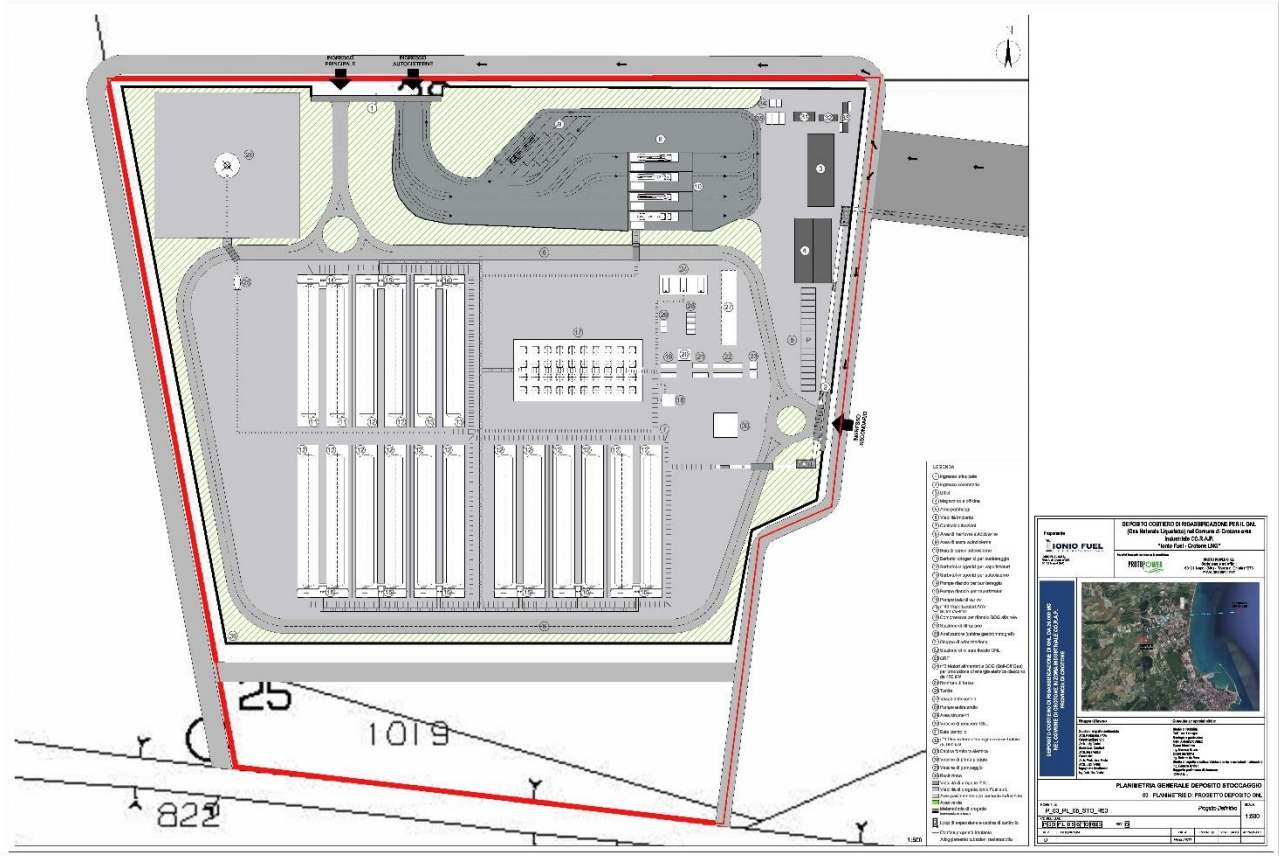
P_03_PL_05_STO_R03- Planimetria generale Deposito di stoccaggio
